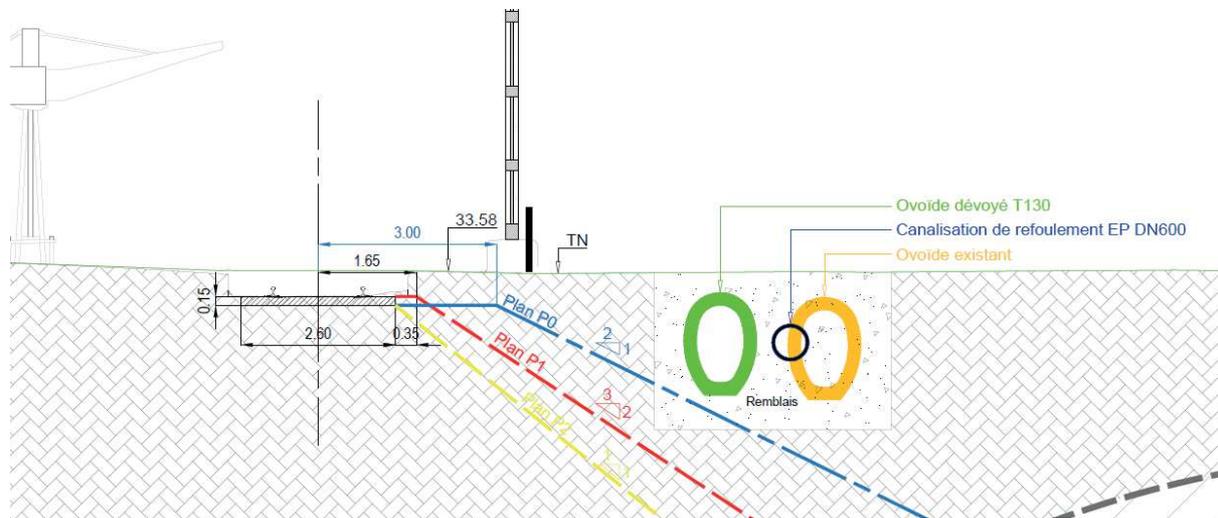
Coupe sur canalisations – CT04 (Coupe BB' Architecte)
